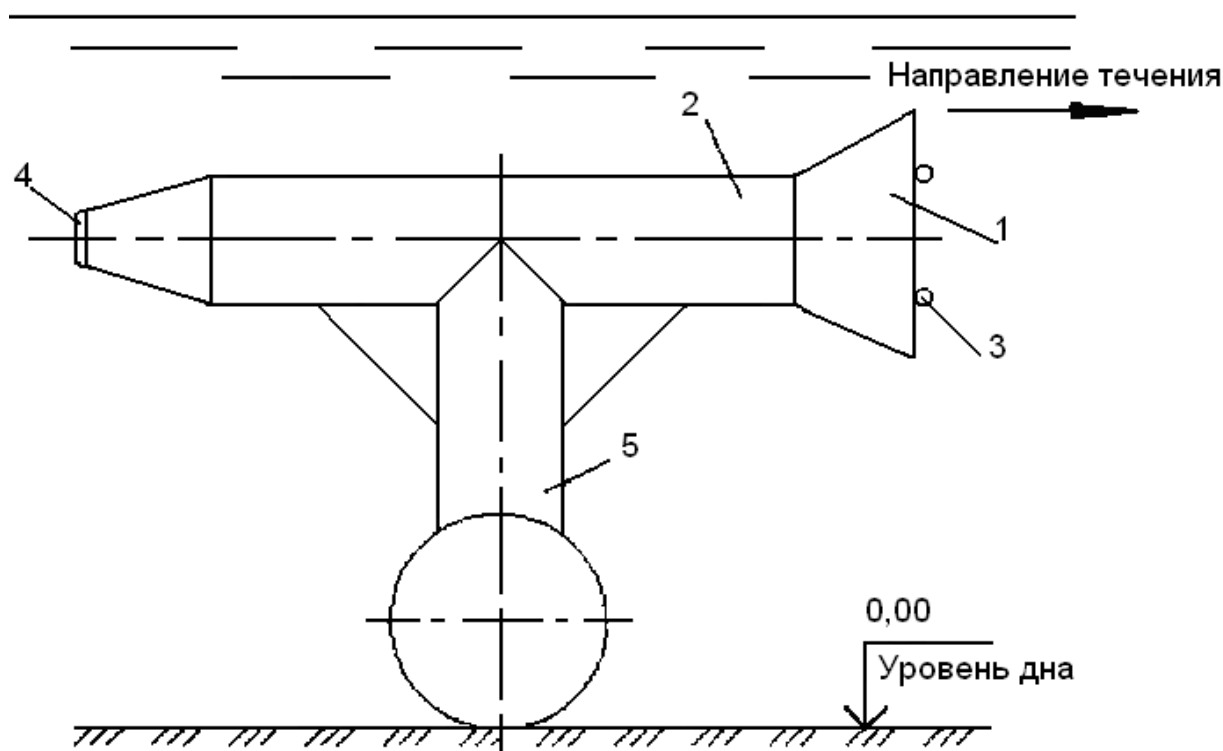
Трубчатый оголовок: 1 – конический диффузор; 2 – отводной цилиндр; 3 – связи из стальных прутков; 4 – заглушка; 5 – отводной патрубок
